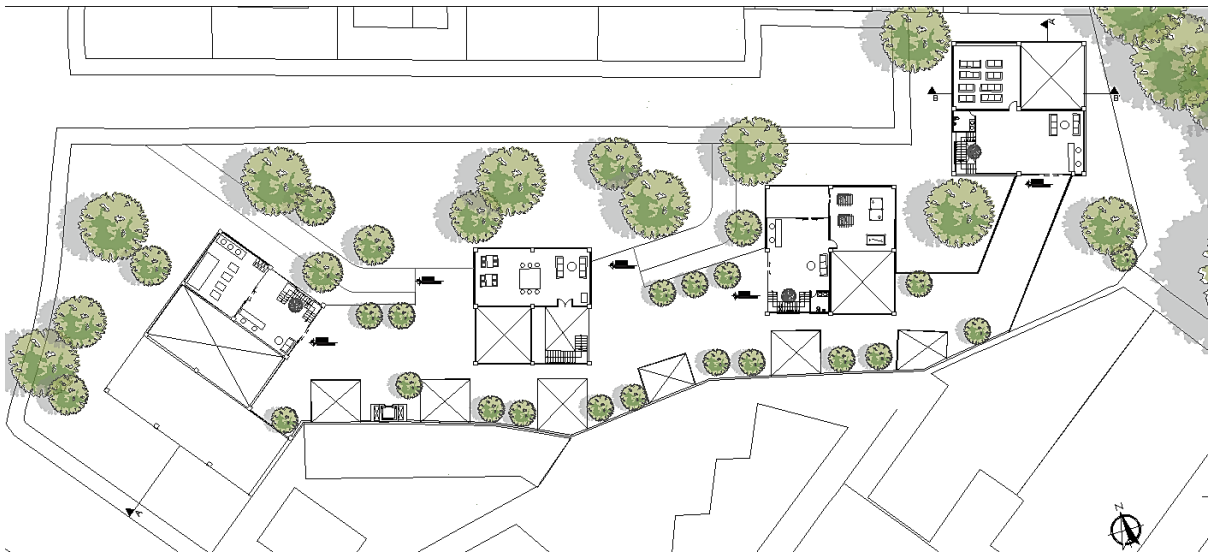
Planta Baja – área comunal viviendas. Elaboración propia.
